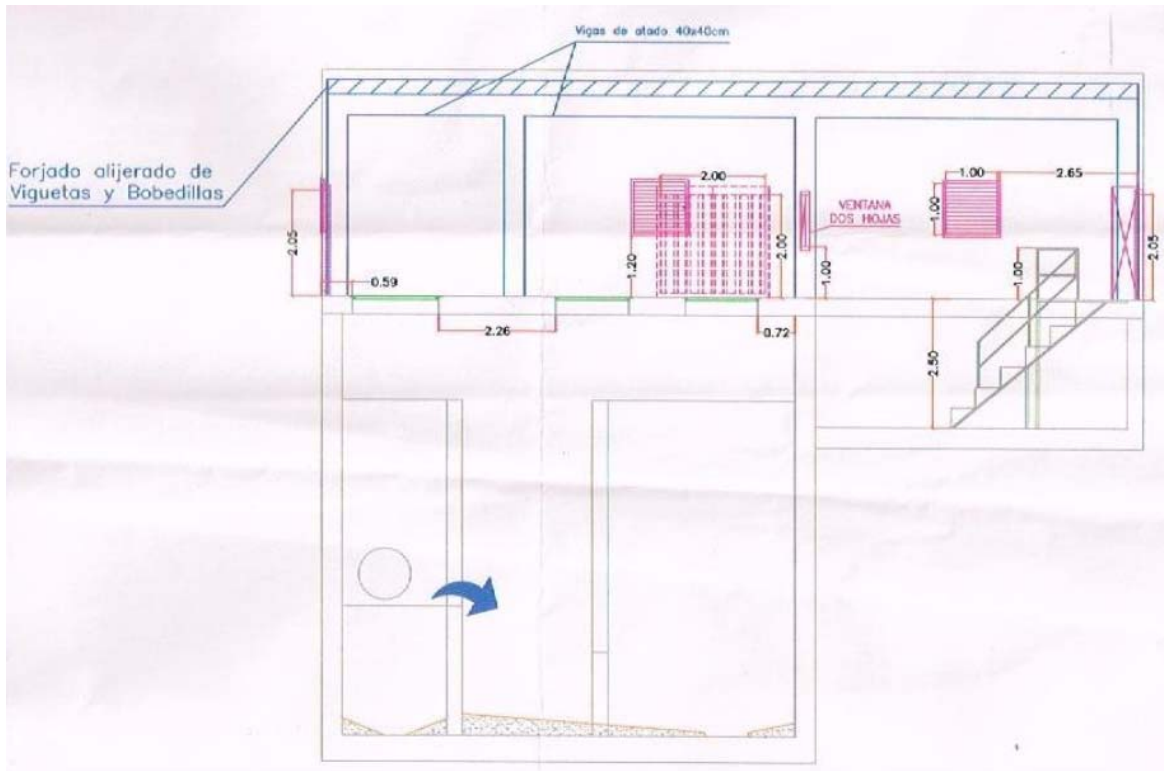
Sección vertical pozo de bombeo. Fuente: Proyecto de ejecución EBAR el Rubial. Juan García Bermejo (2011).
